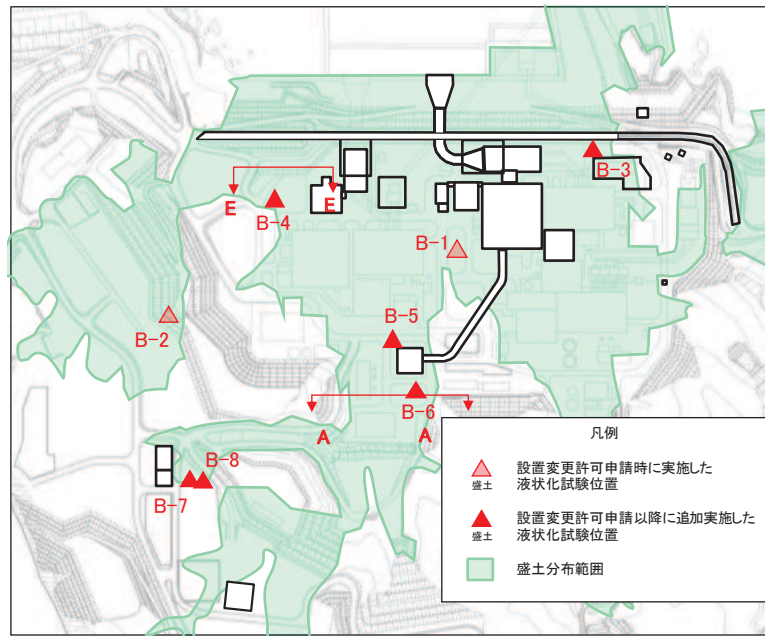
(1) 盛土の液状化強度試験に用いる試料採取位置断面図(1/3)
